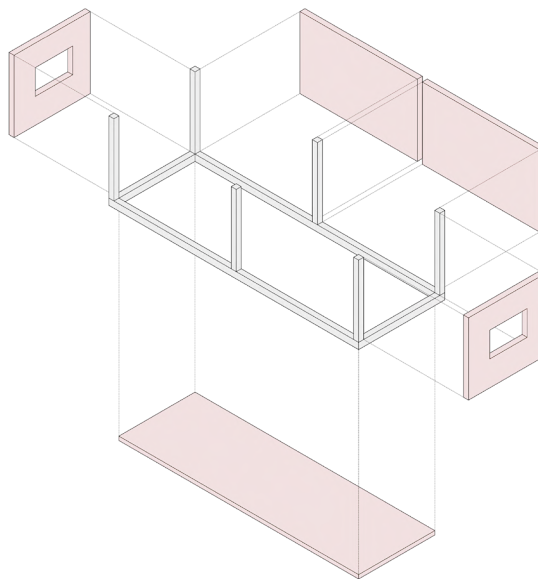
Stahlbeton-Modul ohne Stahlbetonsohle
